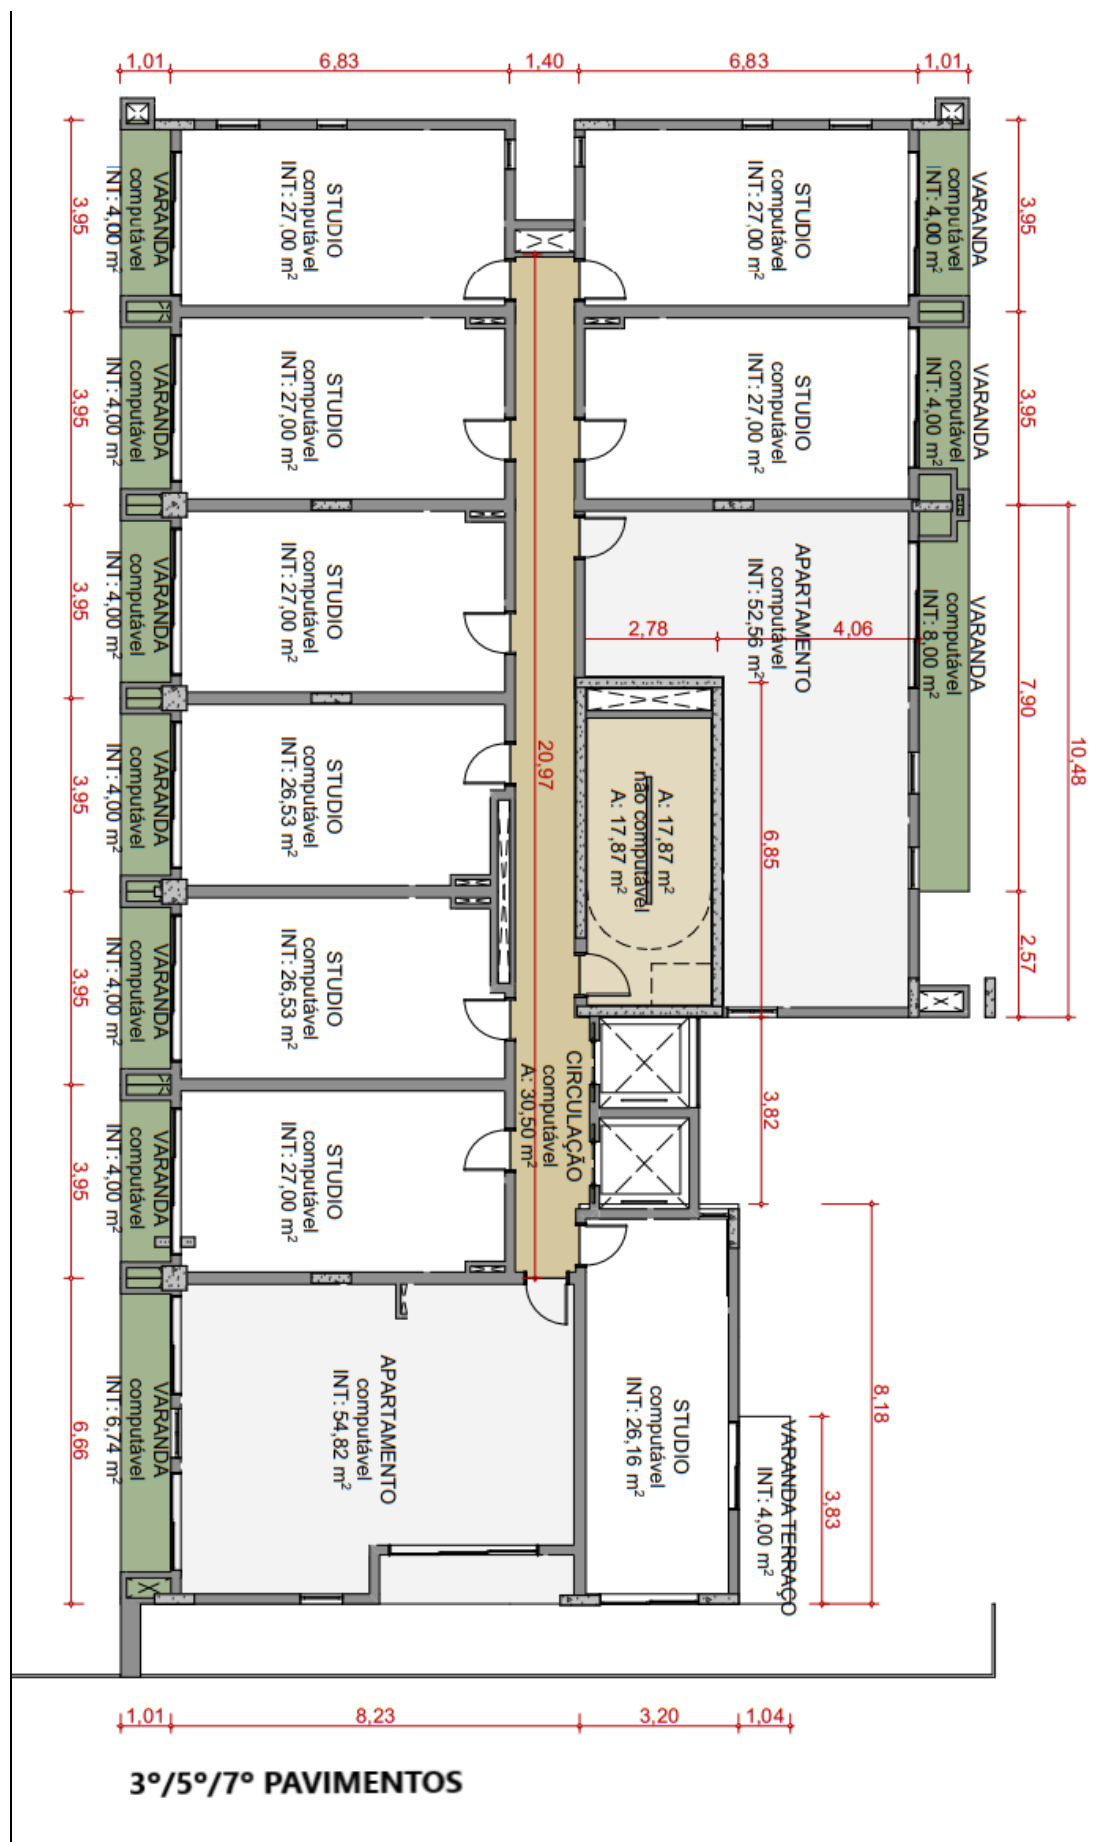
Planta Tipo do 3º/5º e 7º Pavimentos do Condomínio Sintropia Sky Garden.
